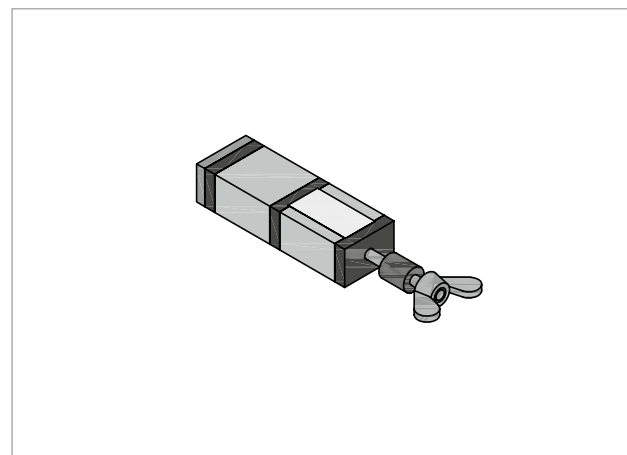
Schöck Tronsole® Typ Q: Montageelement
